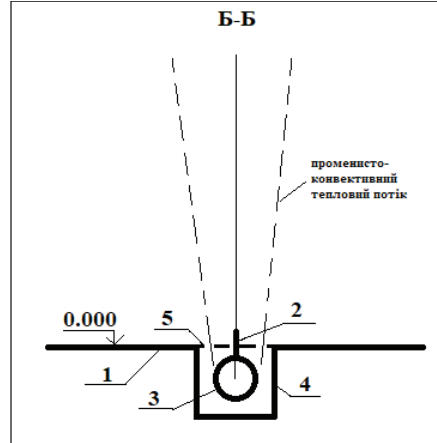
Установка лучистых нагревателей выше уровня земли Разрез Б-Б
